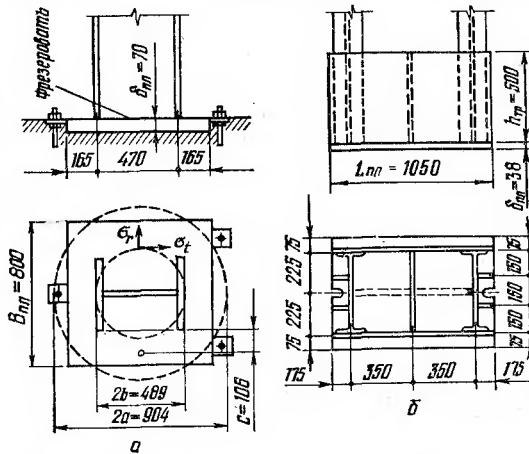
Базы центрально сжатых колонн: а — с фрезерованным торцом; б — с распределительной конструкцией.
